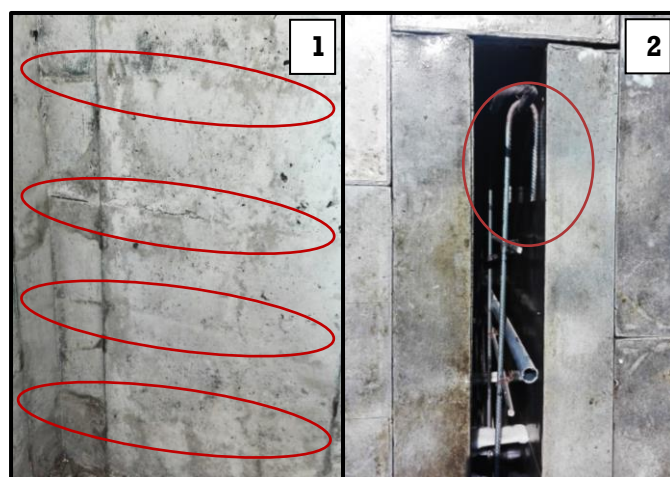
Fisuras en muro con un patrón específico (izquierda). Armadura con nulo recubrimiento previo al vaciado (derecha).
